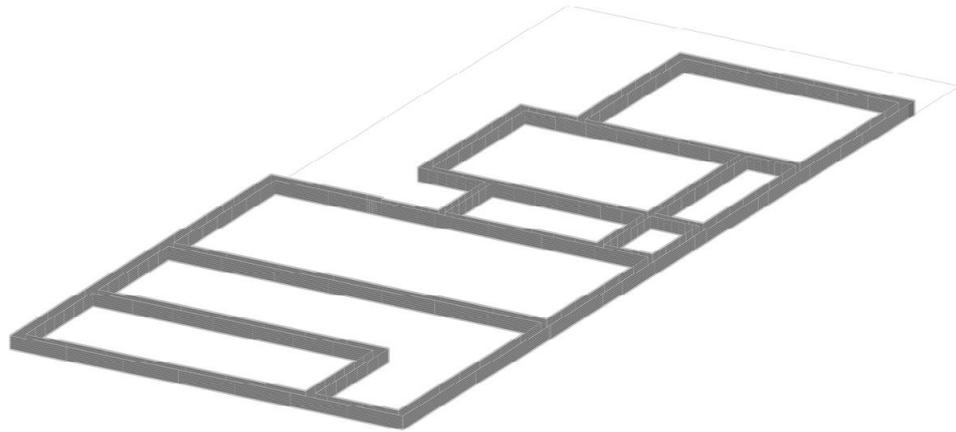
Planta 3D da proposta para pilares em concreto armado
